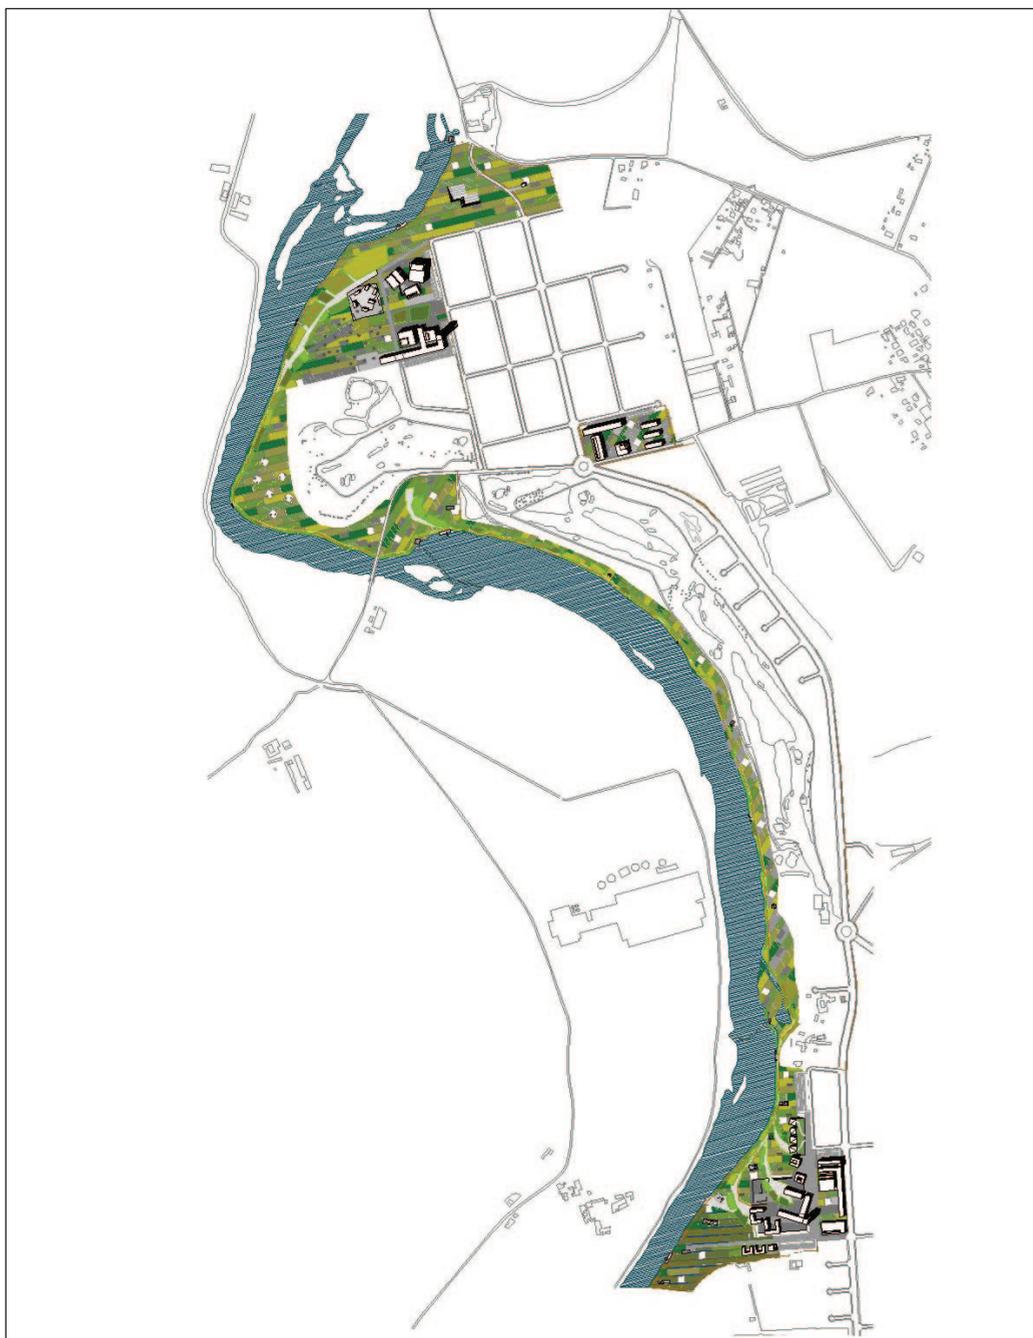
Planta general del nuevo Campus de Villamayor. Arriba: Área Norte; centro: Área Este; abajo: Área Sur.
